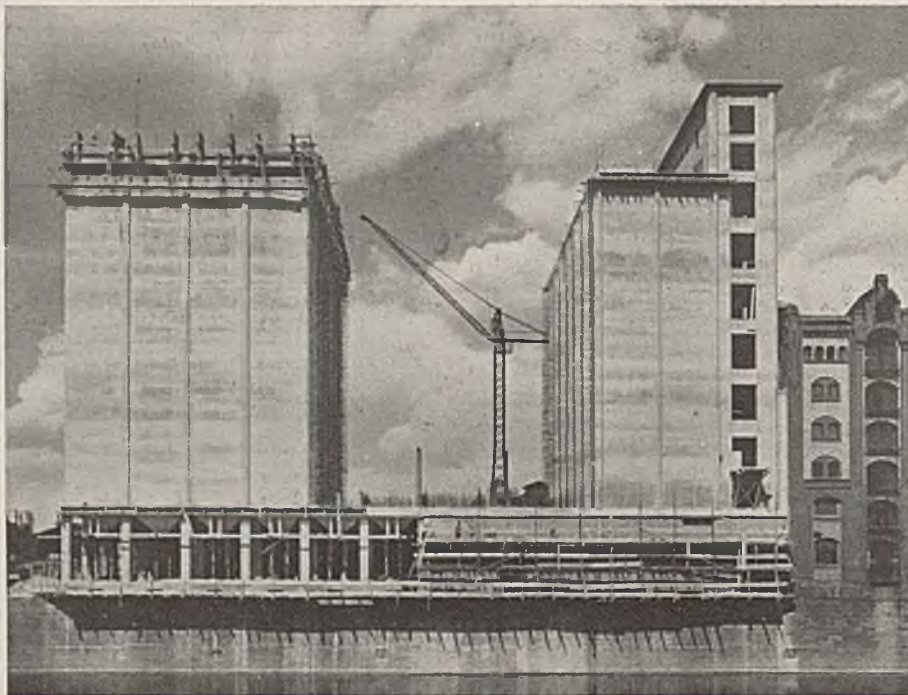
Der erste und zweite Bauabschnitt sind fertiggestellt, die Gleitschalung wird abgebaut.
